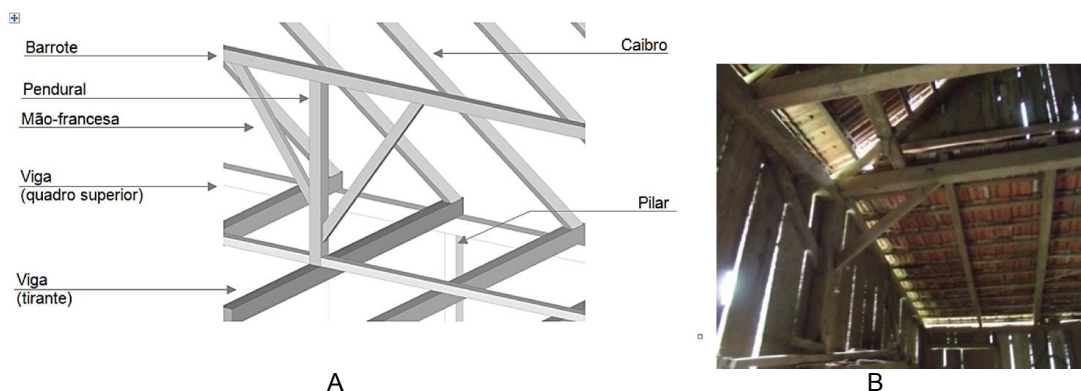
DETALHE DA ESTRUTURA DA CASA MAJCZAK (A), ESTRUTURA DO MOINHO SCHAPIESKI (B).
